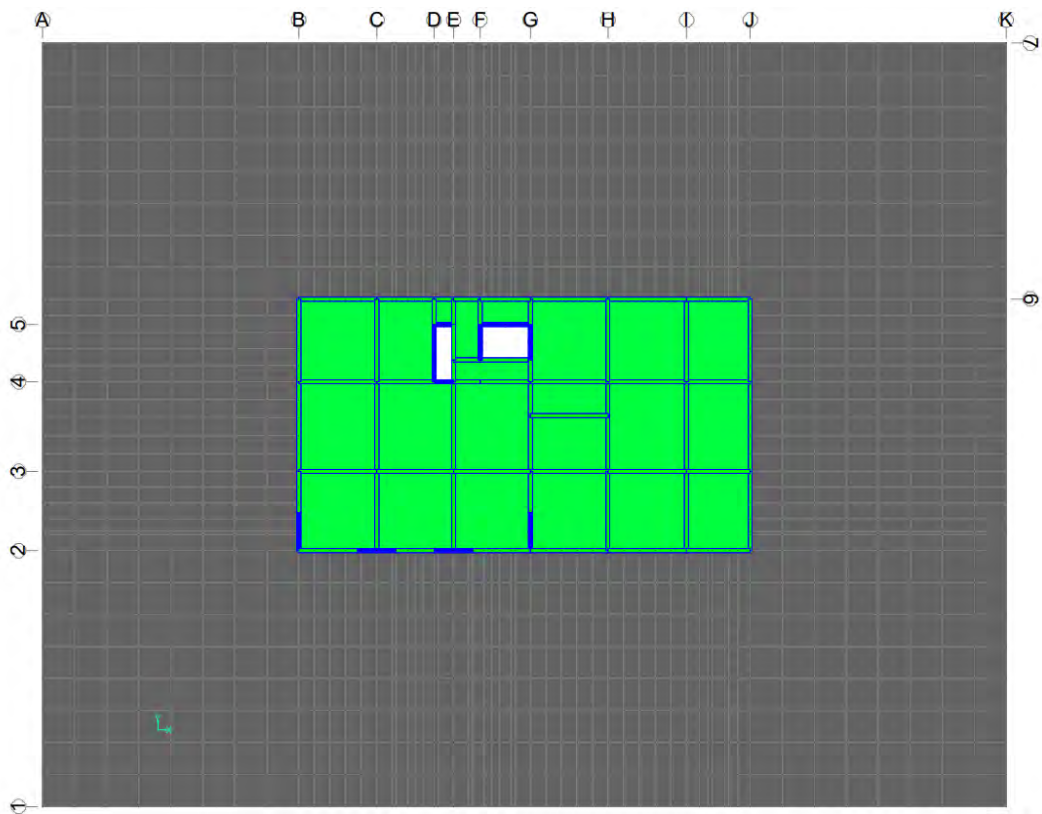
Vista en planta de sótano 1 del Modelo estructural 3. Fuente: propia.
